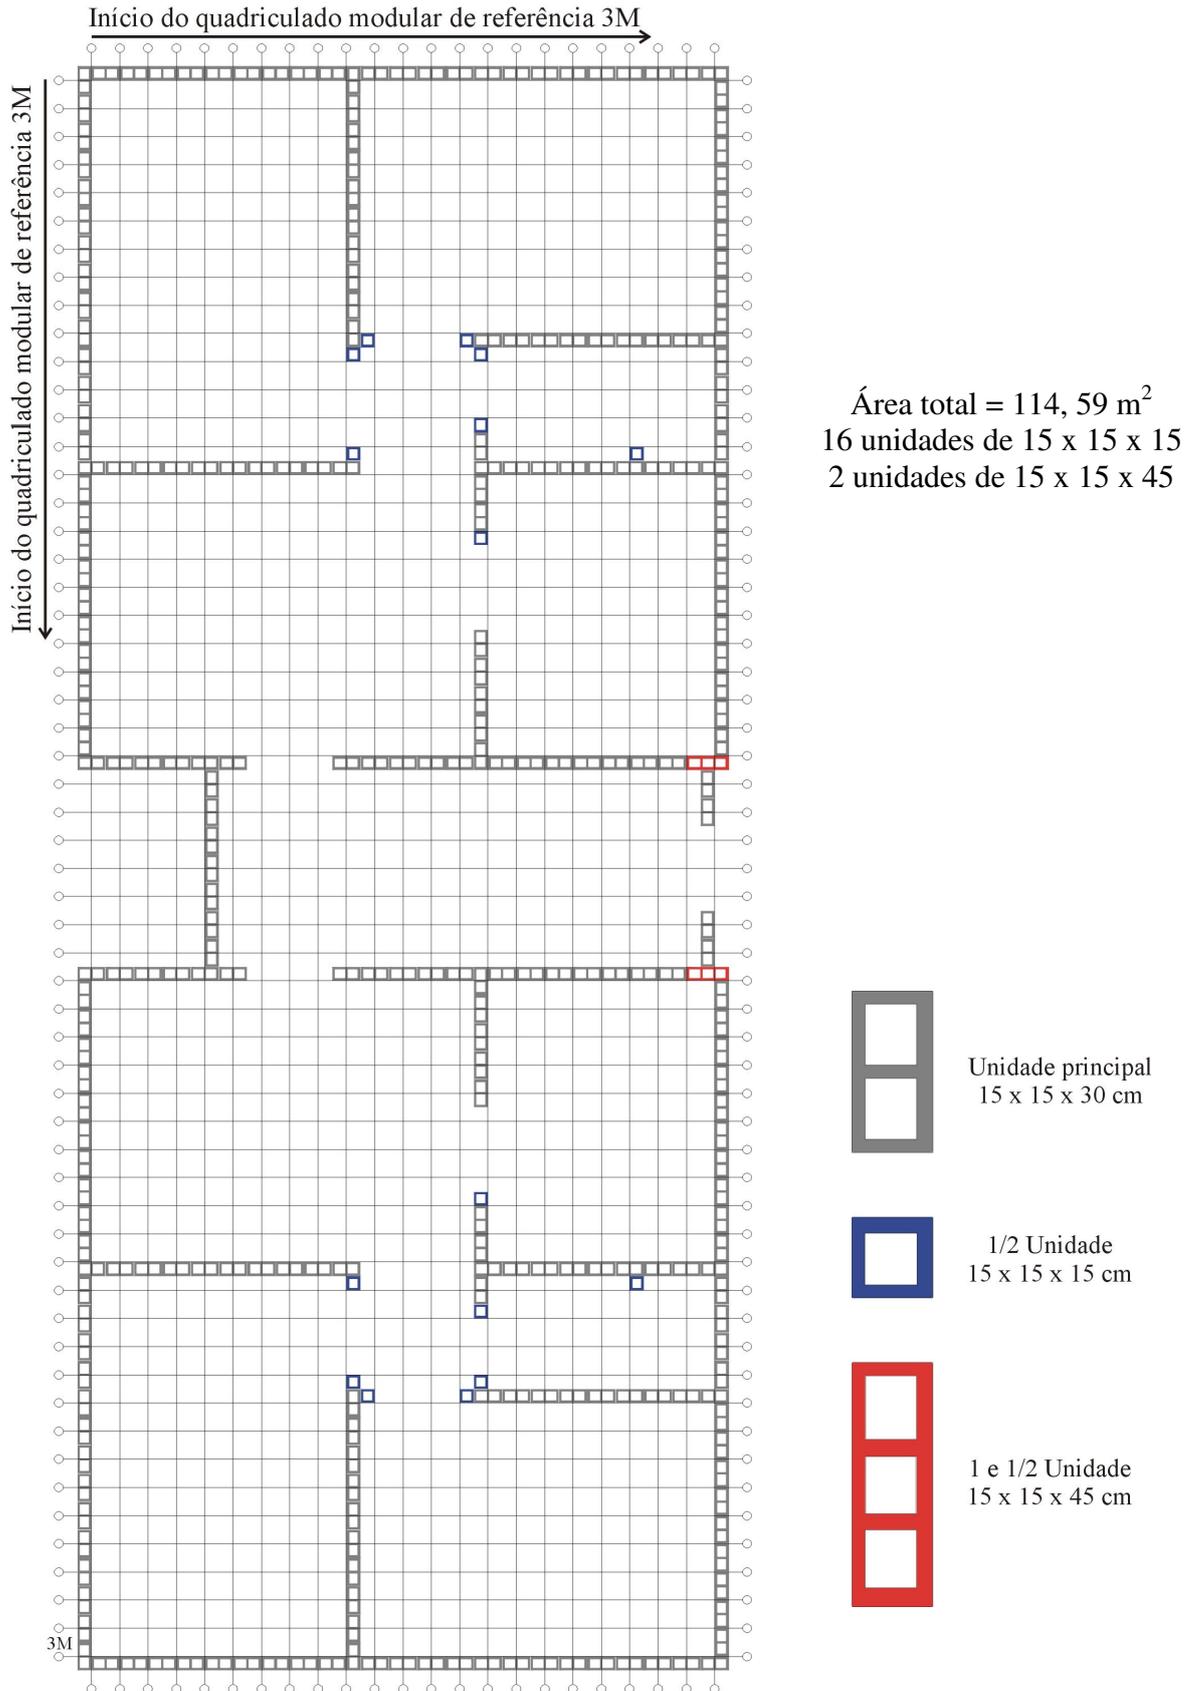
paginação da primeira fiada do pavimento tipo do projeto piloto com as unidades de alvenaria estrutural propostas
